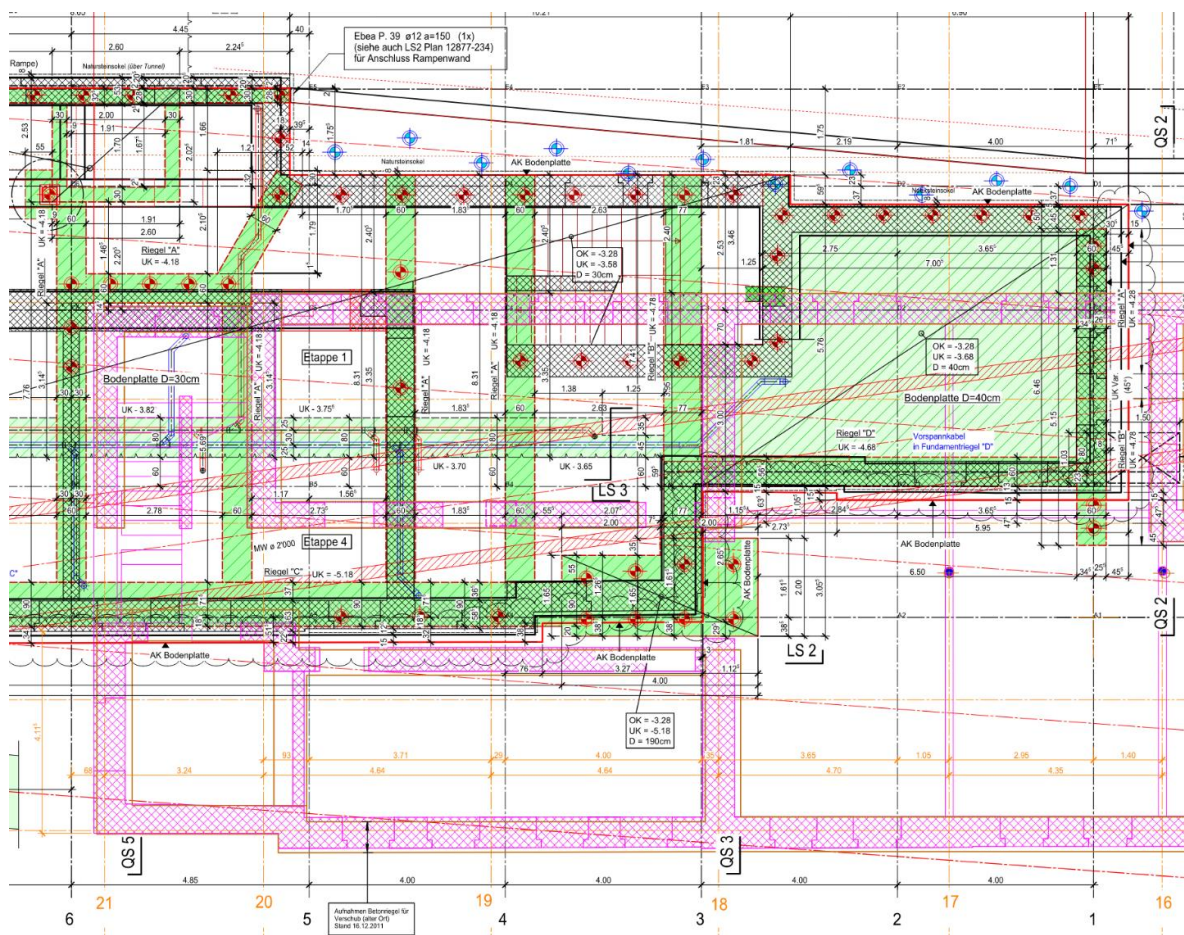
, Zona de solape entre los ejes 1 - 6 y 16 – 21
